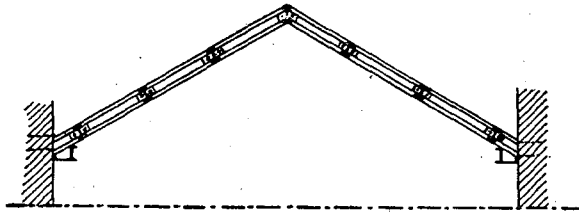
Entramado de cubierta, constituido por pares solamente.
